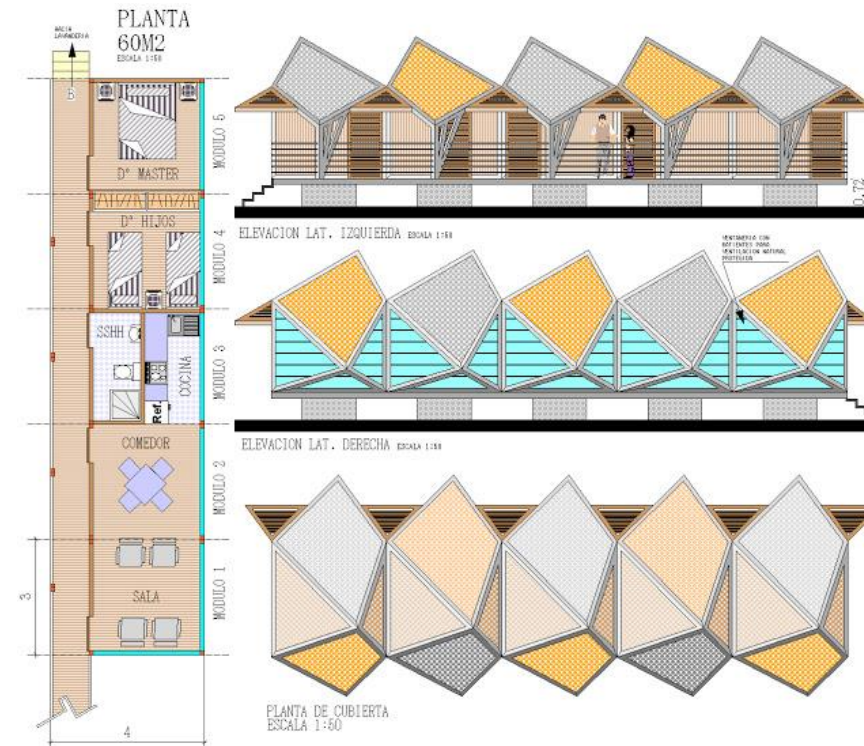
Planta Viviendas Emergentes para Inundaciones
